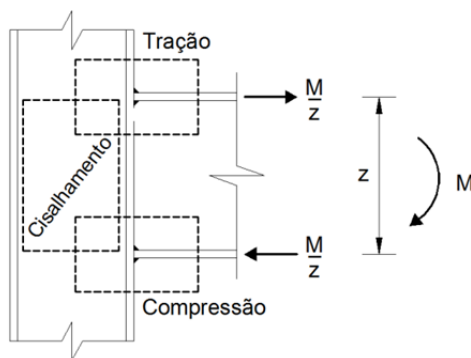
Regiões de tração, compressão e cisalhamento numa ligação viga-pilar.
